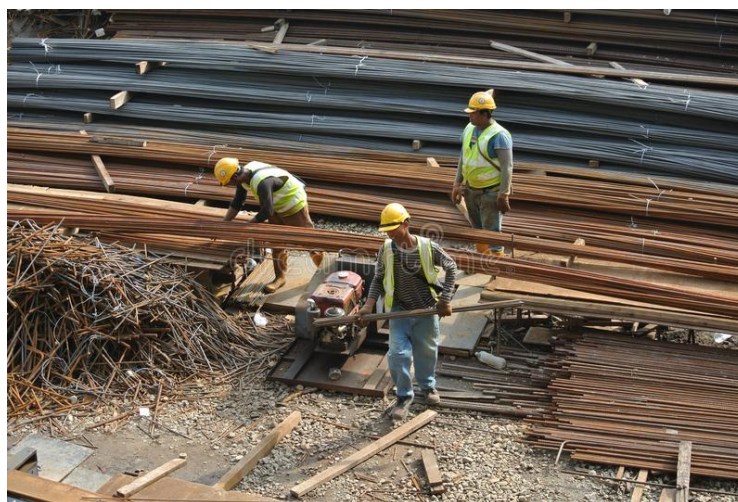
Lavorazione dell'acciaio in cantiere.
